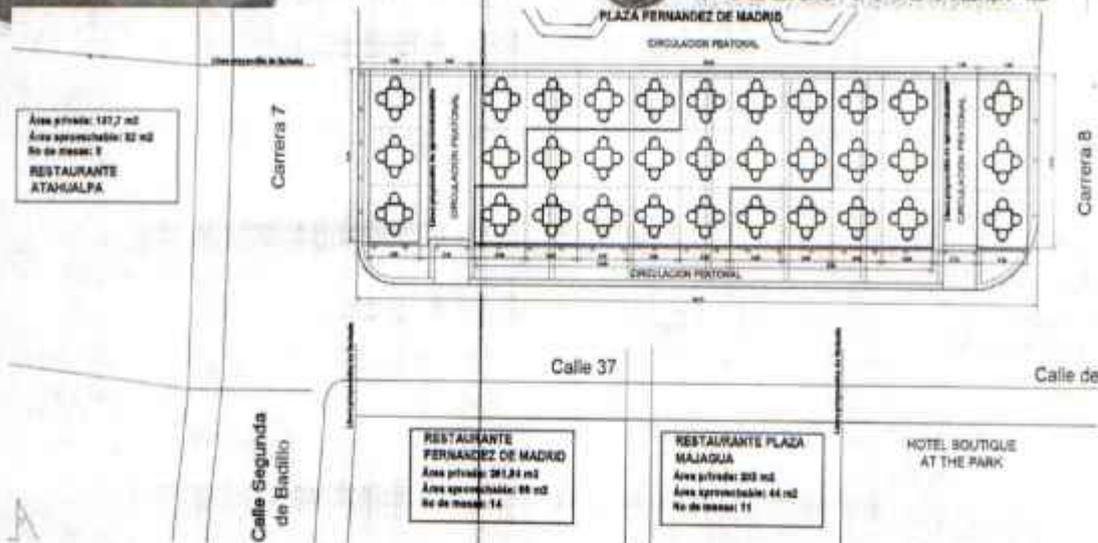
Plano PLAZA FERNANDEZ DE MADRID -Distribución de mobiliario Calle 37
